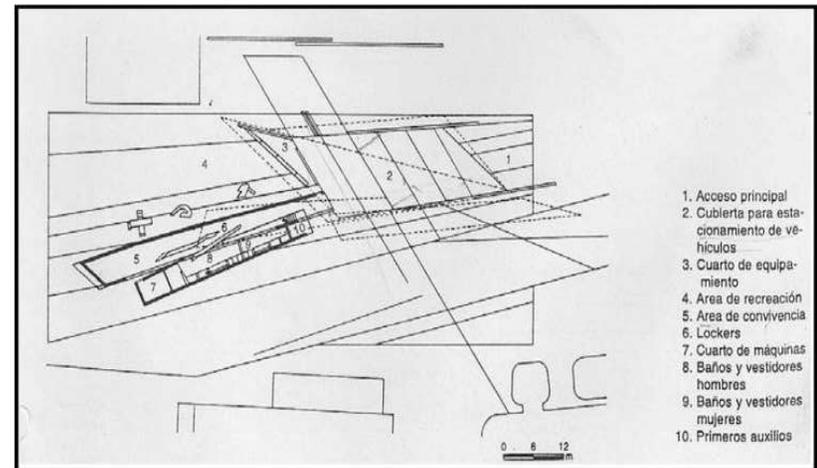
Planta Baja de la central de bomberos de Vitra.
